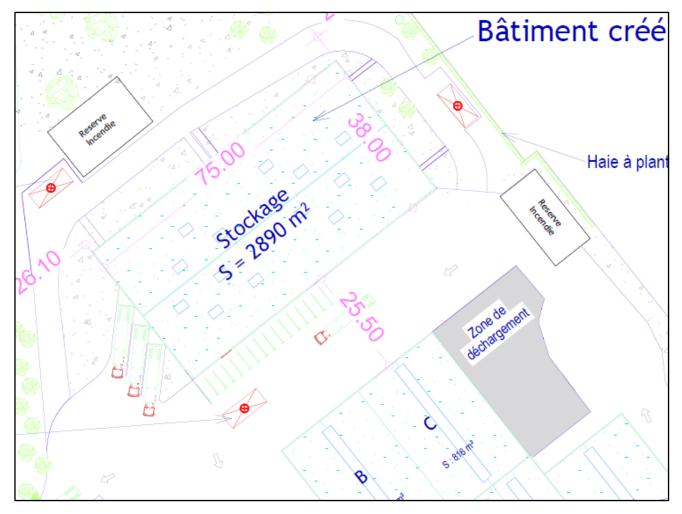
Aménagement futur de bâtiment (source : sicabconstruction)
